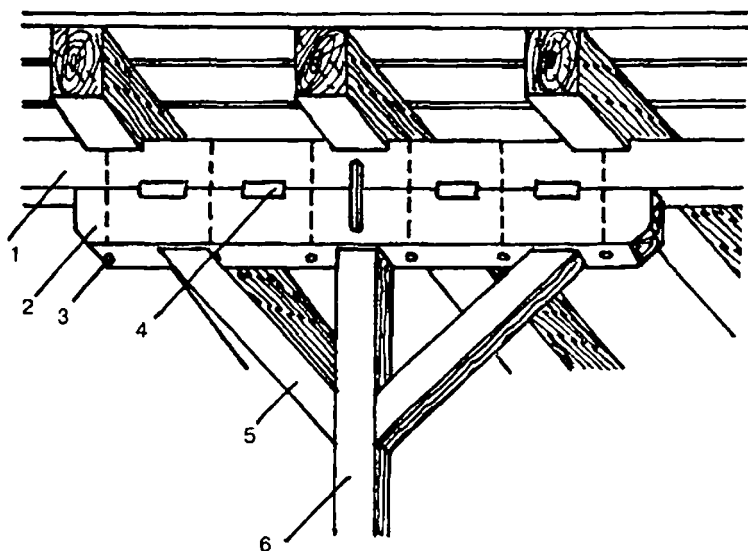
Укрепление балок перекрытия промежуточными столбами:
